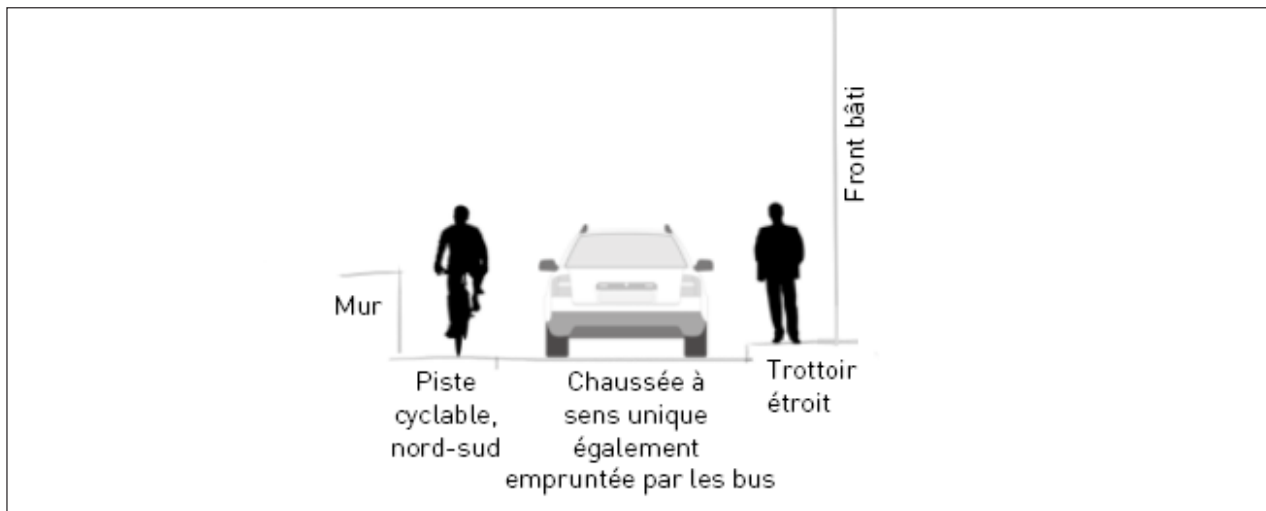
Coupe sur l'avenue Louis-Vulliemin, selon sa forme en contrebas du quartier (source : Joëlle Gaillard)
